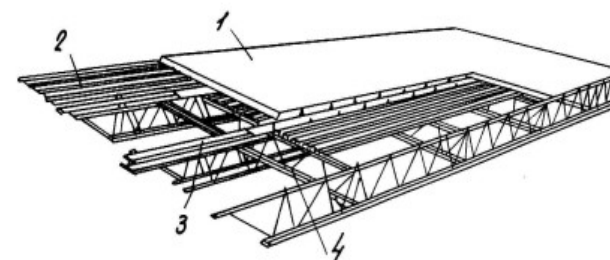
Перекрытие, выполненное по 2-й конструктивной схеме
